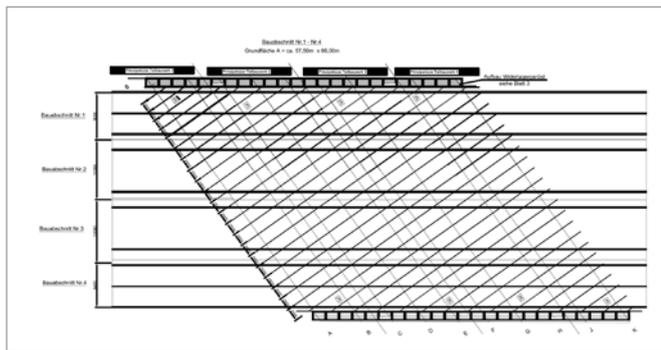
Grundriss des fertigen Hängegerüsts über der Autobahn A40, Quelle: Ingenieure Tomshöfer & Partner, Bochum
